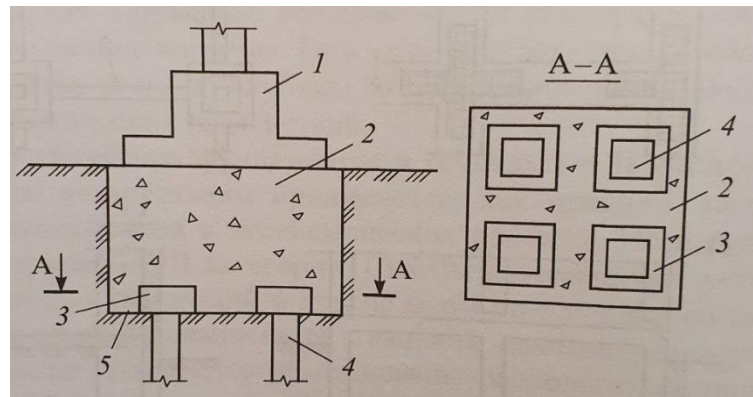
Свайный фундамент с промежуточной подушкой:
